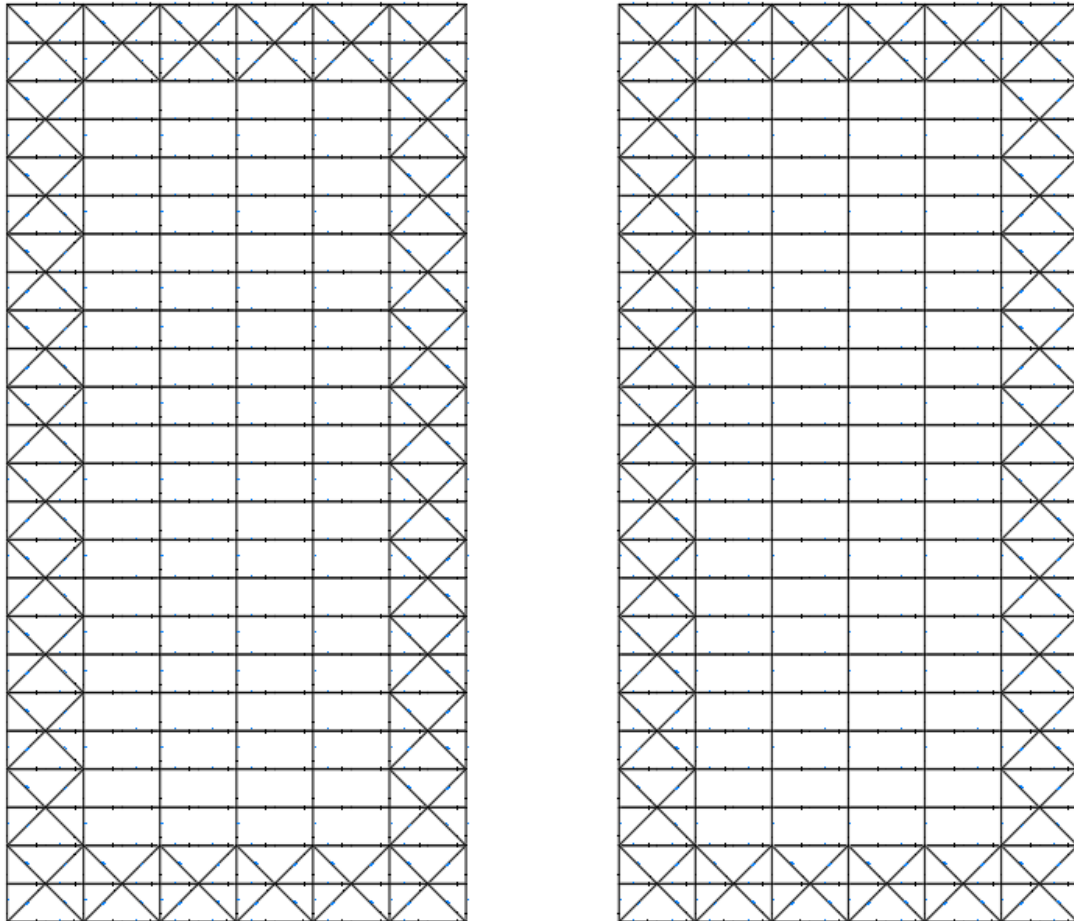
Vista en planta a la altura del cordón inferior de la cercha del Pabellón 1 y 2.
